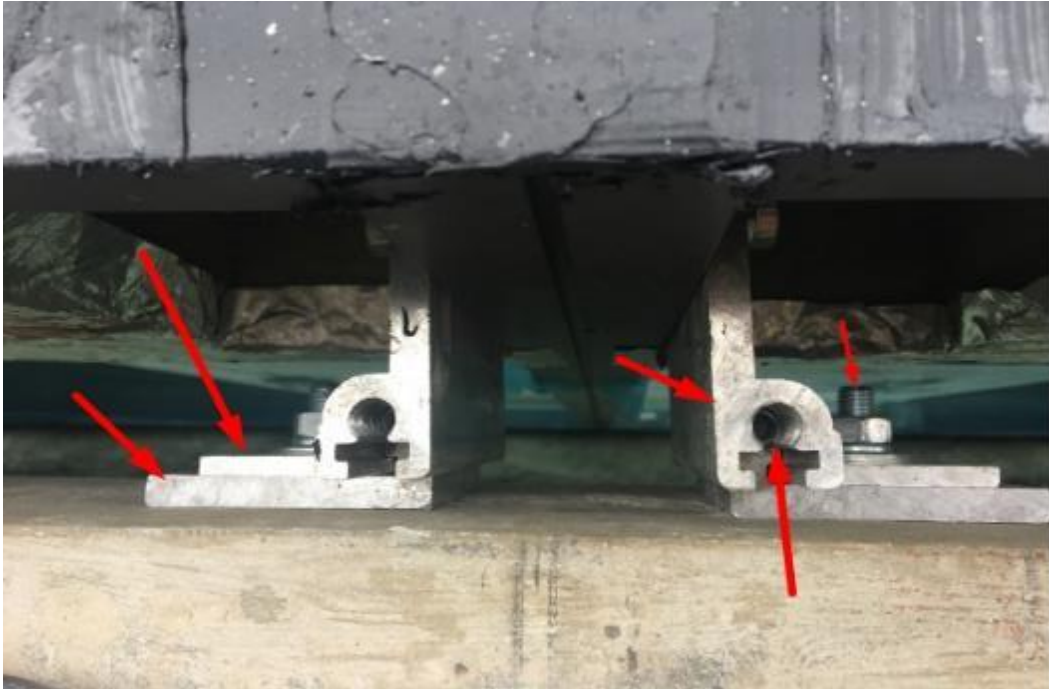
Sistema de anclaje ensamblado. Fuente: Propia (2020)
